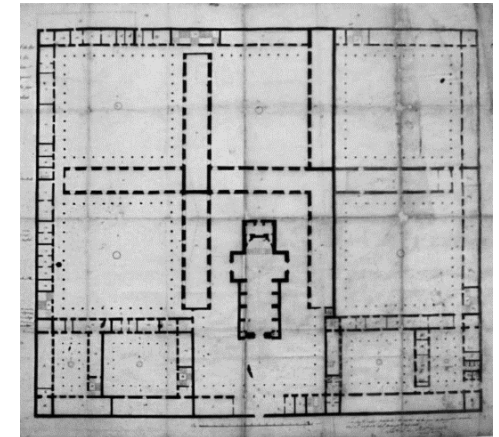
Planta del Hospital de Las Cinco Llagas de Sevilla.
